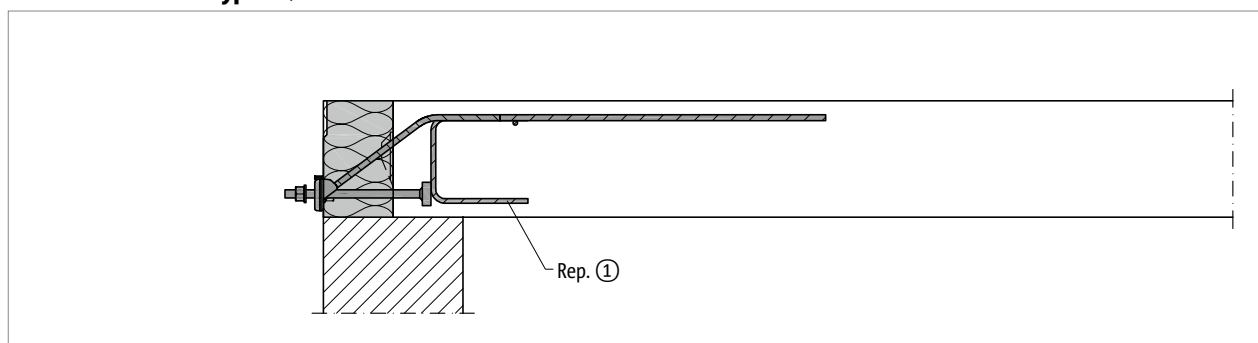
Schöck Isokorb® XT type SQ : armatures à prévoir par le client, vue en coupe
